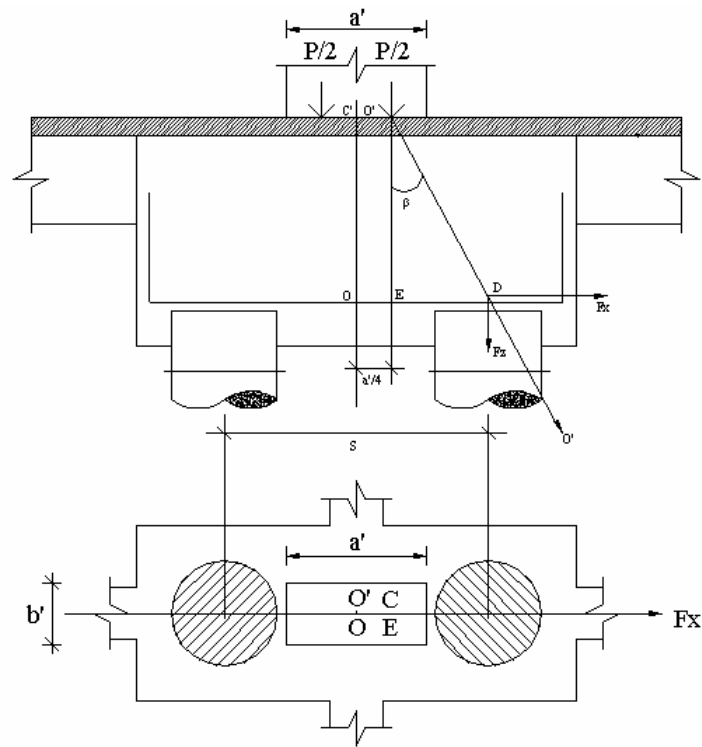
Fuerzas en el cabezal considerando las dimensiones de la columnas⁹
